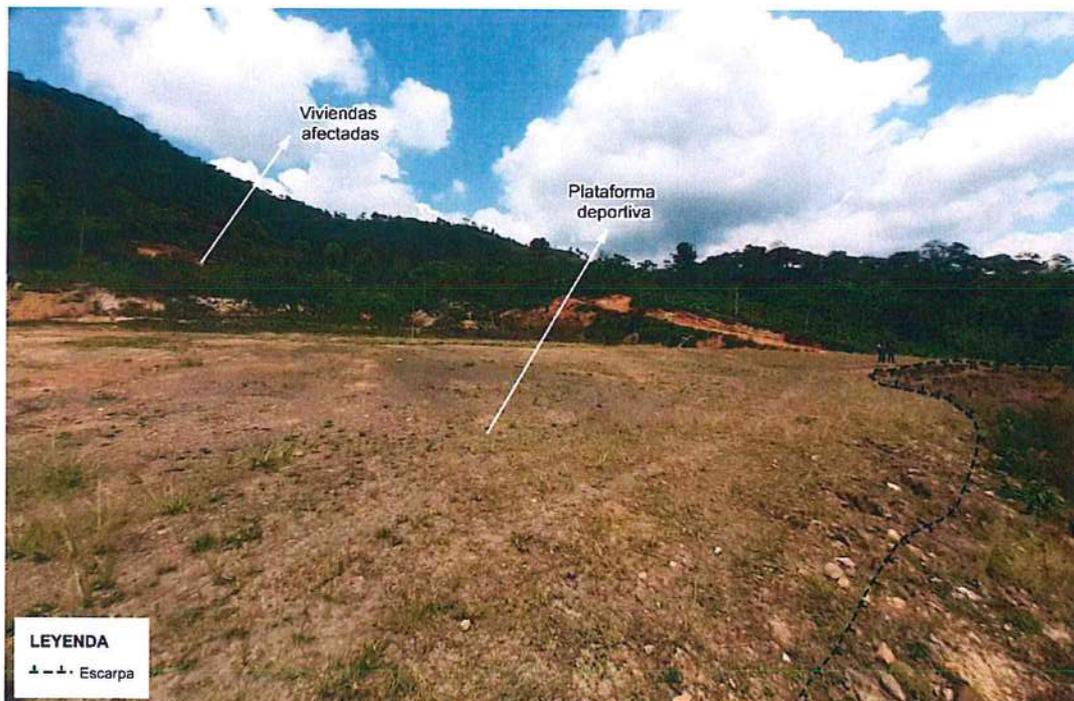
Vista de la excavación inadecuada y corte de la ladera, para la construcción de una plataforma deportiva en el caserío Los Ángeles.
